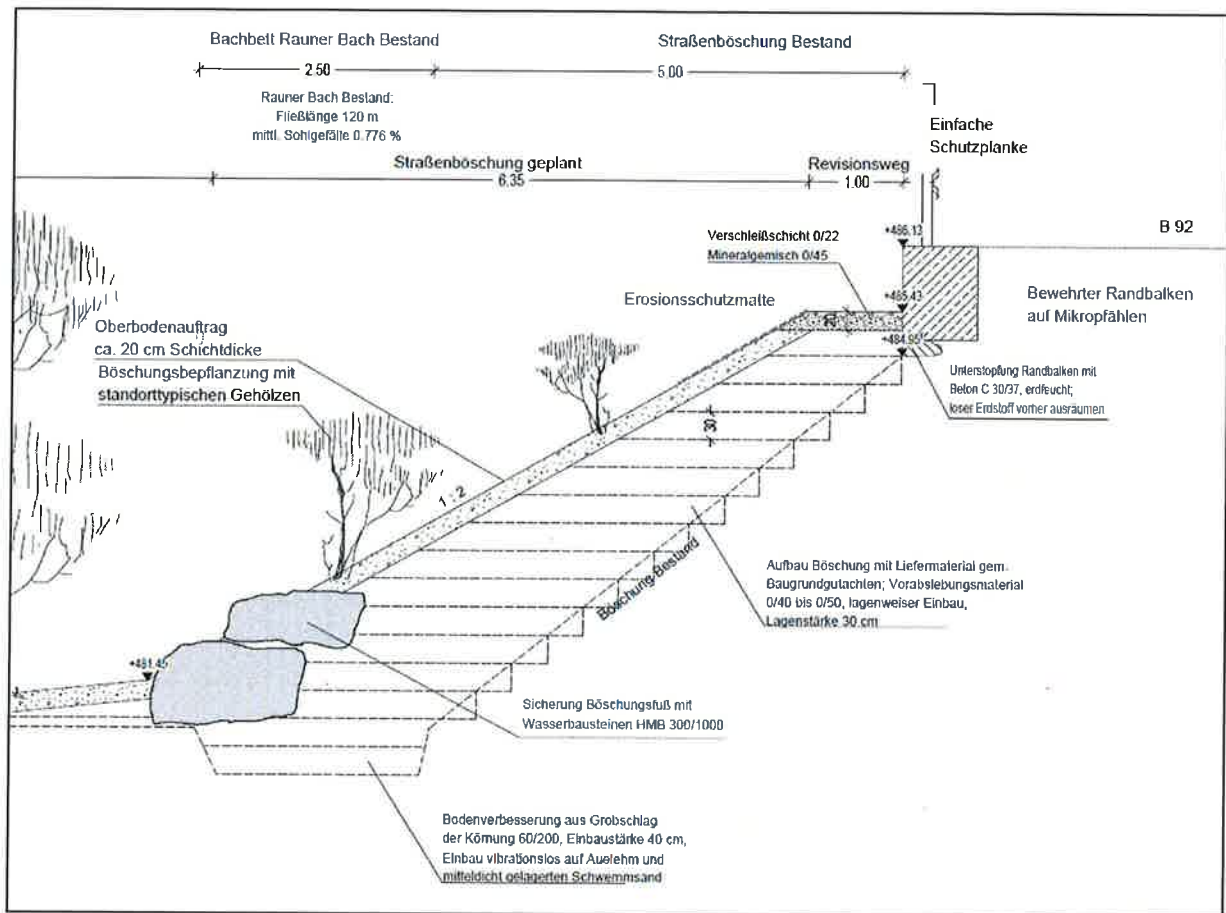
Ausschnitt Geländeschnitt Schnitt A-A mit geplanter Straßenböschung (aus [Anlage 5.2](#), [LAS-21])
